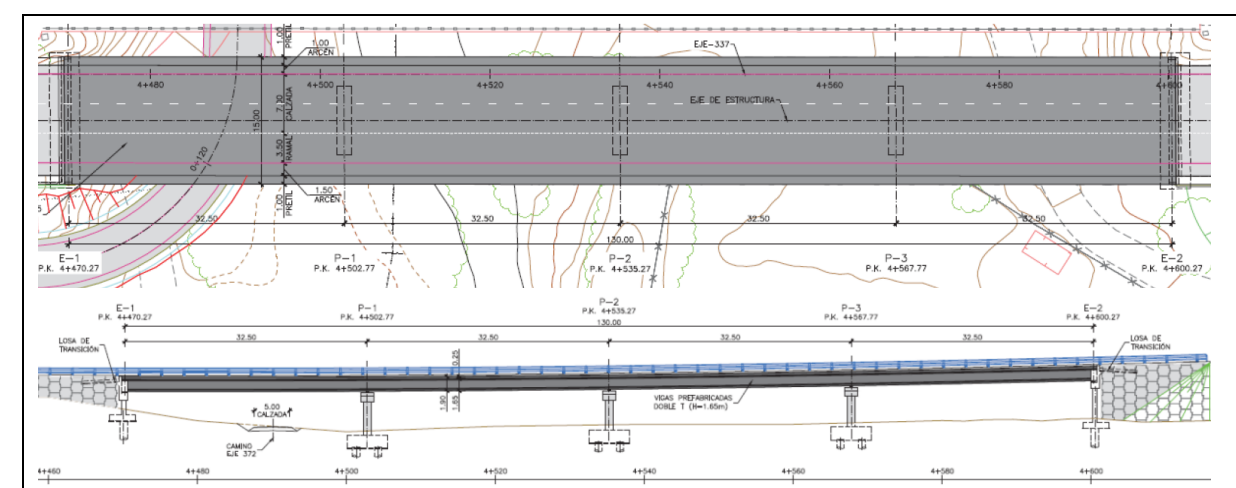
Viaducto 16+625 VS MI proyectado. Planta y alzado
